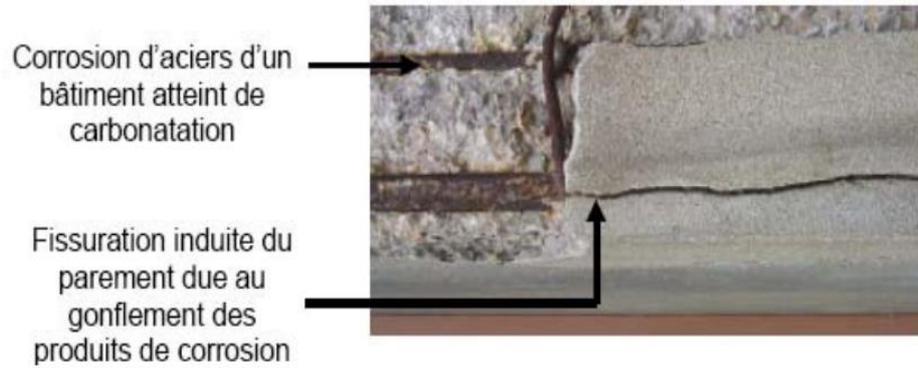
Eclatement du béton sous l'effet de la corrosion des armatures
